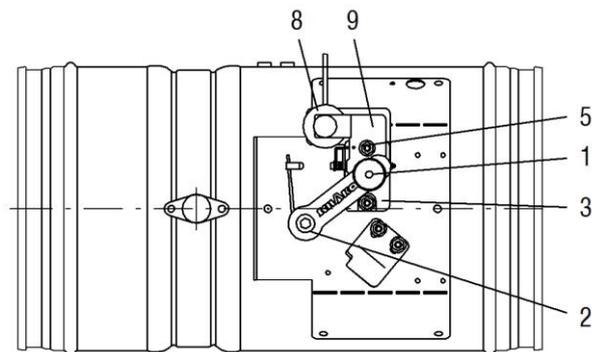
Seitenansicht BSK-RPR (Handauslösung und Magnet)
